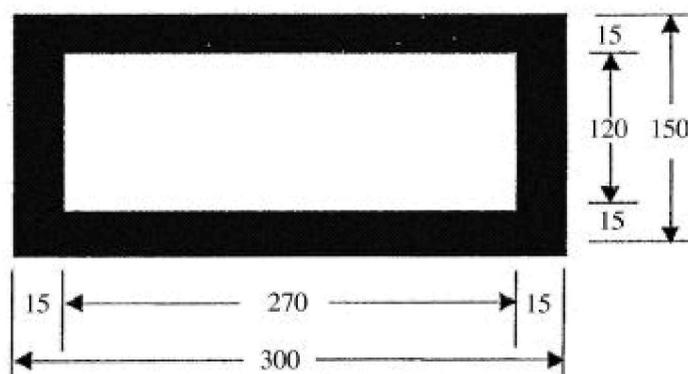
ひび割れ抵抗性試験用供試体（単位：mm）
